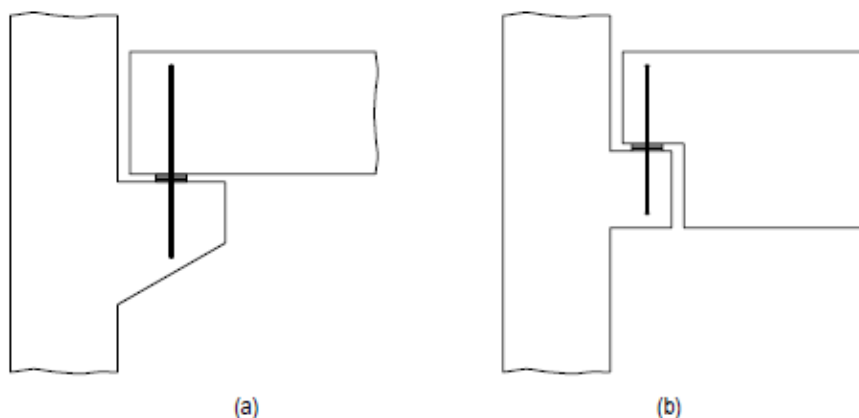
Ligação viga-pilar por meio de elastômero e chumbador
